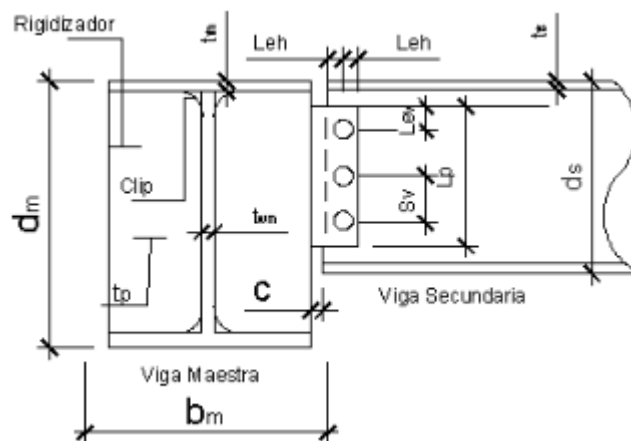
Geometría de conexión viga maestra-viga secundaria.
